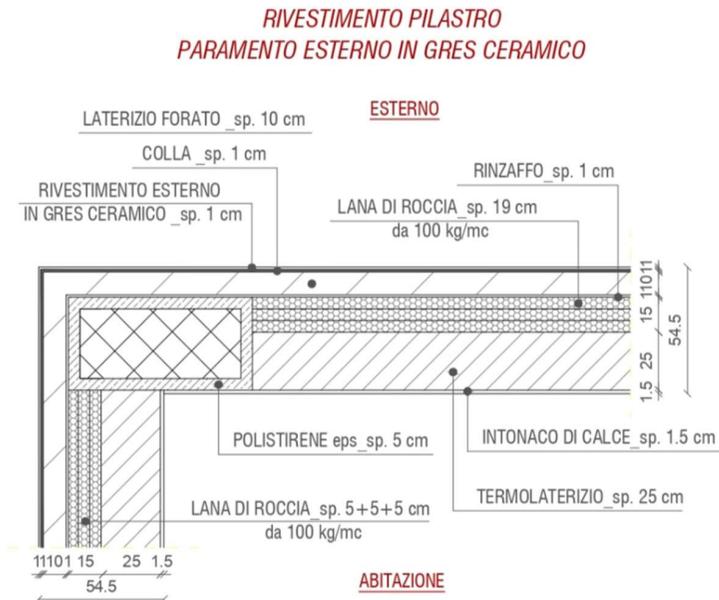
Stratigrafia muratura perimetrale con rivestimento esterno in gres.
